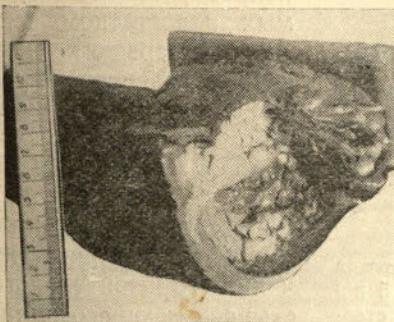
Дефектный стык стержней диаметром 70 мм, разрушившийся при испытании; зашлаковка и непровар зоны сплавления и несплавление флангового шва с металлом стержня; предел прочности стыка  $29 \text{ кг}/\text{мм}^2$
